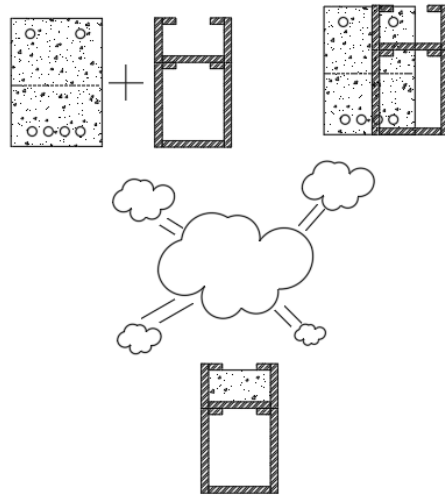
Viga compuesta rellena, Sección N°2 o principal.
